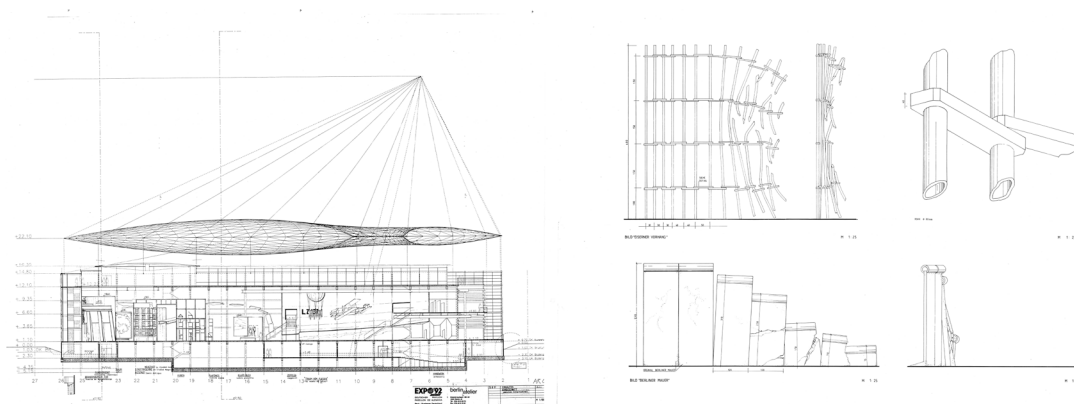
Sección del diseño de montaje expositivo para el Pabellón de Alemania y planos de detalle del Muro de Berlín y el Telón de
